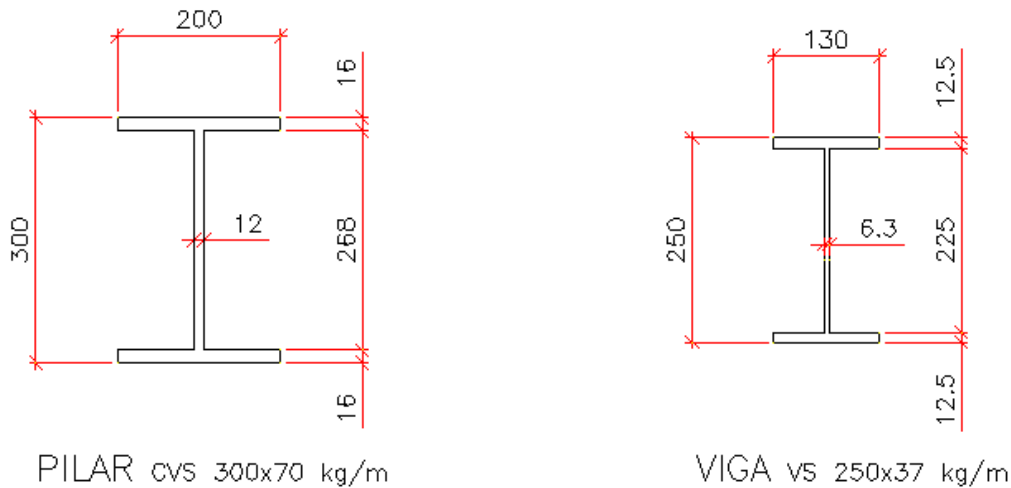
Dimensões das seções transversais dos perfis do pilar e da viga utilizados na modelagem
